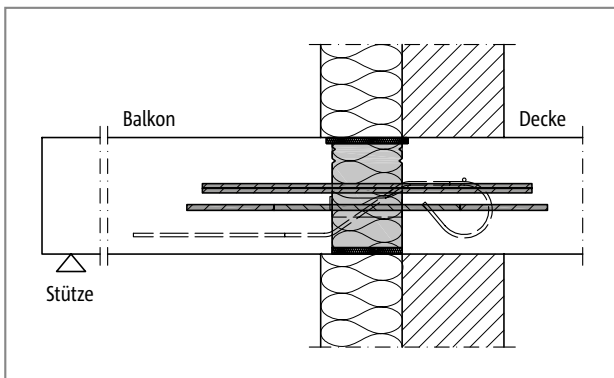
Schöck Isokorb® XT Typ Q, HP-VV-NN: Mauerwerk mit Außendämmung
